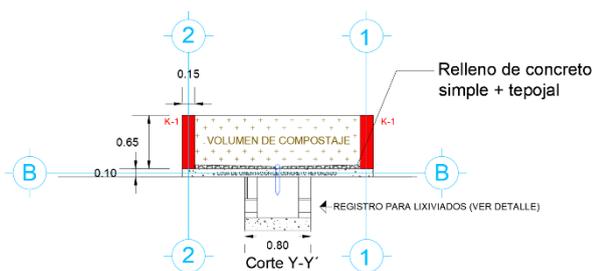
Plano en corte Y-Y' del diseño de la cimentación de la planta de lombricompostaje. Elaboración propia (2022).
